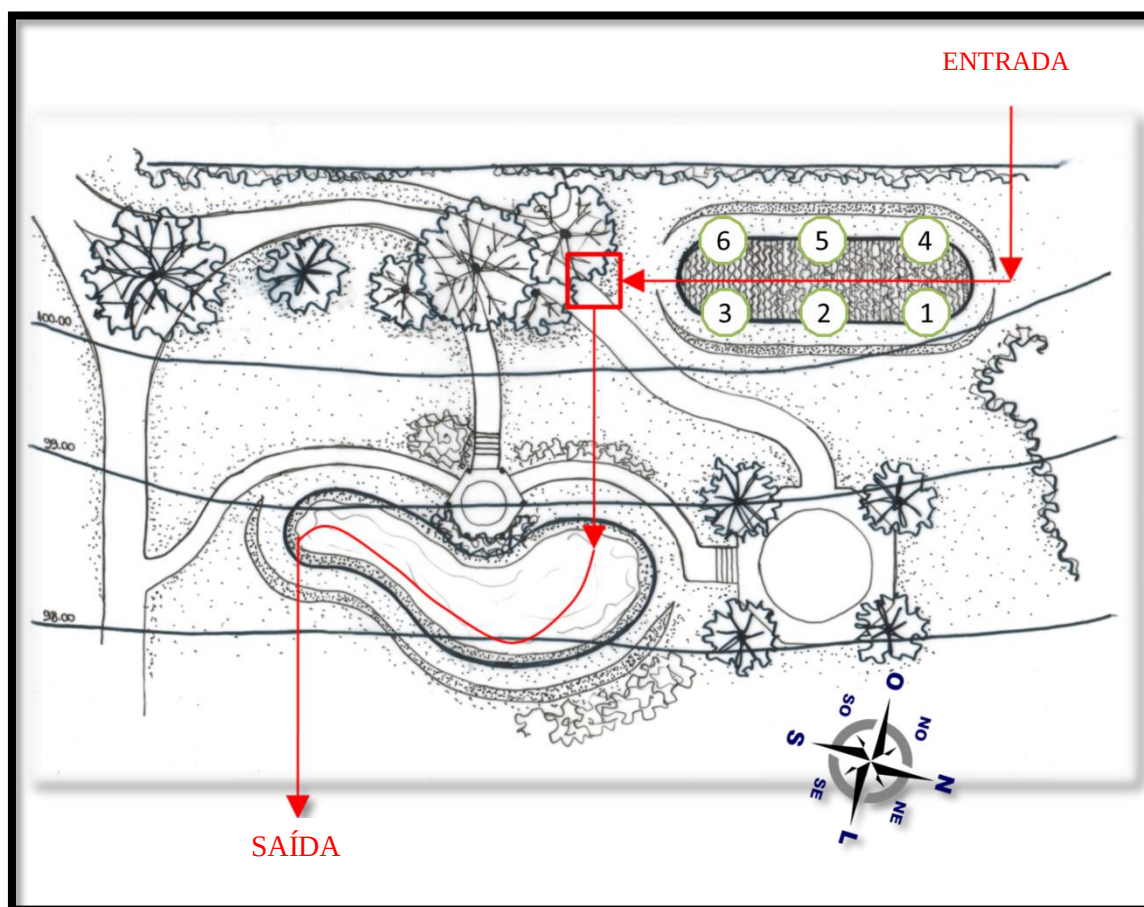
Locação das plantas 1,2,3,4,5 e 6 no sistema.
